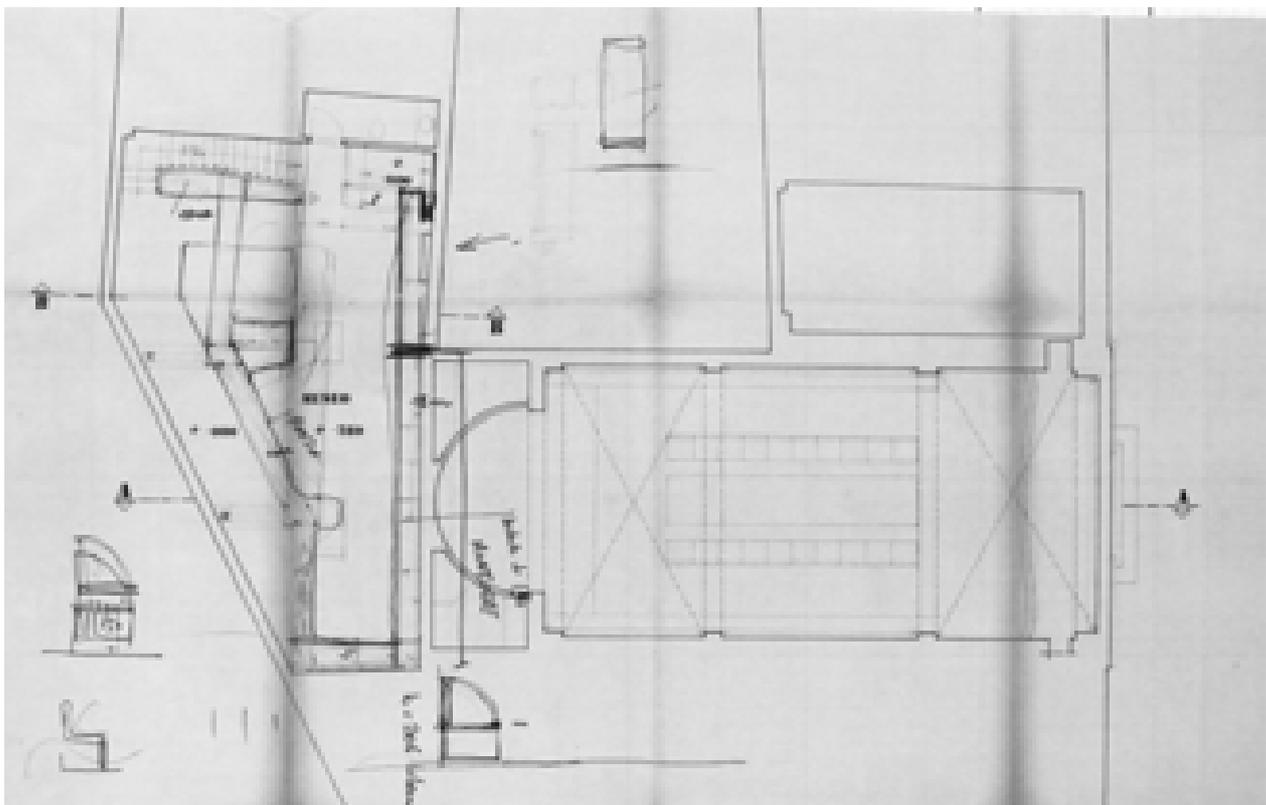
Pianta doppio volume – Stato di progetto – 24/02/1981 (AABS-94.049)
